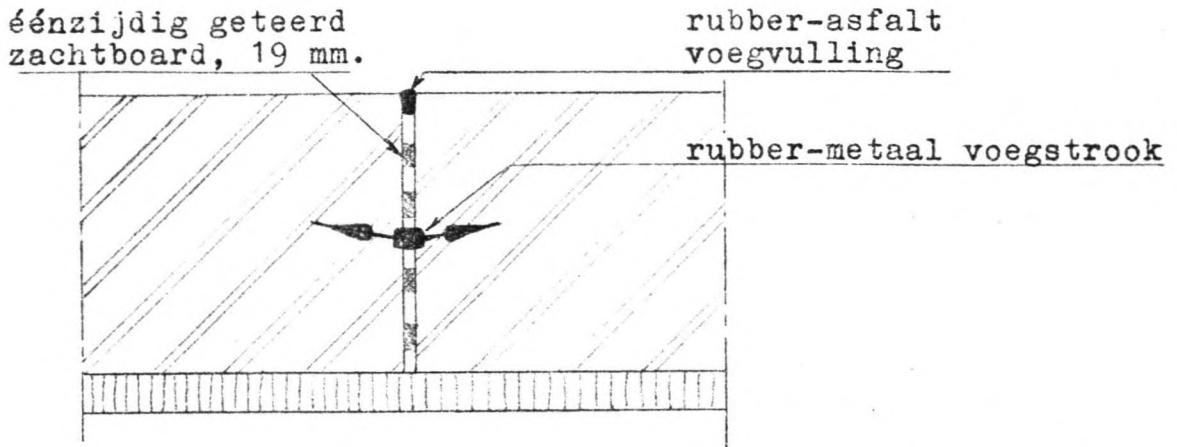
, Detail van de voegconstructie tussen de moten.
